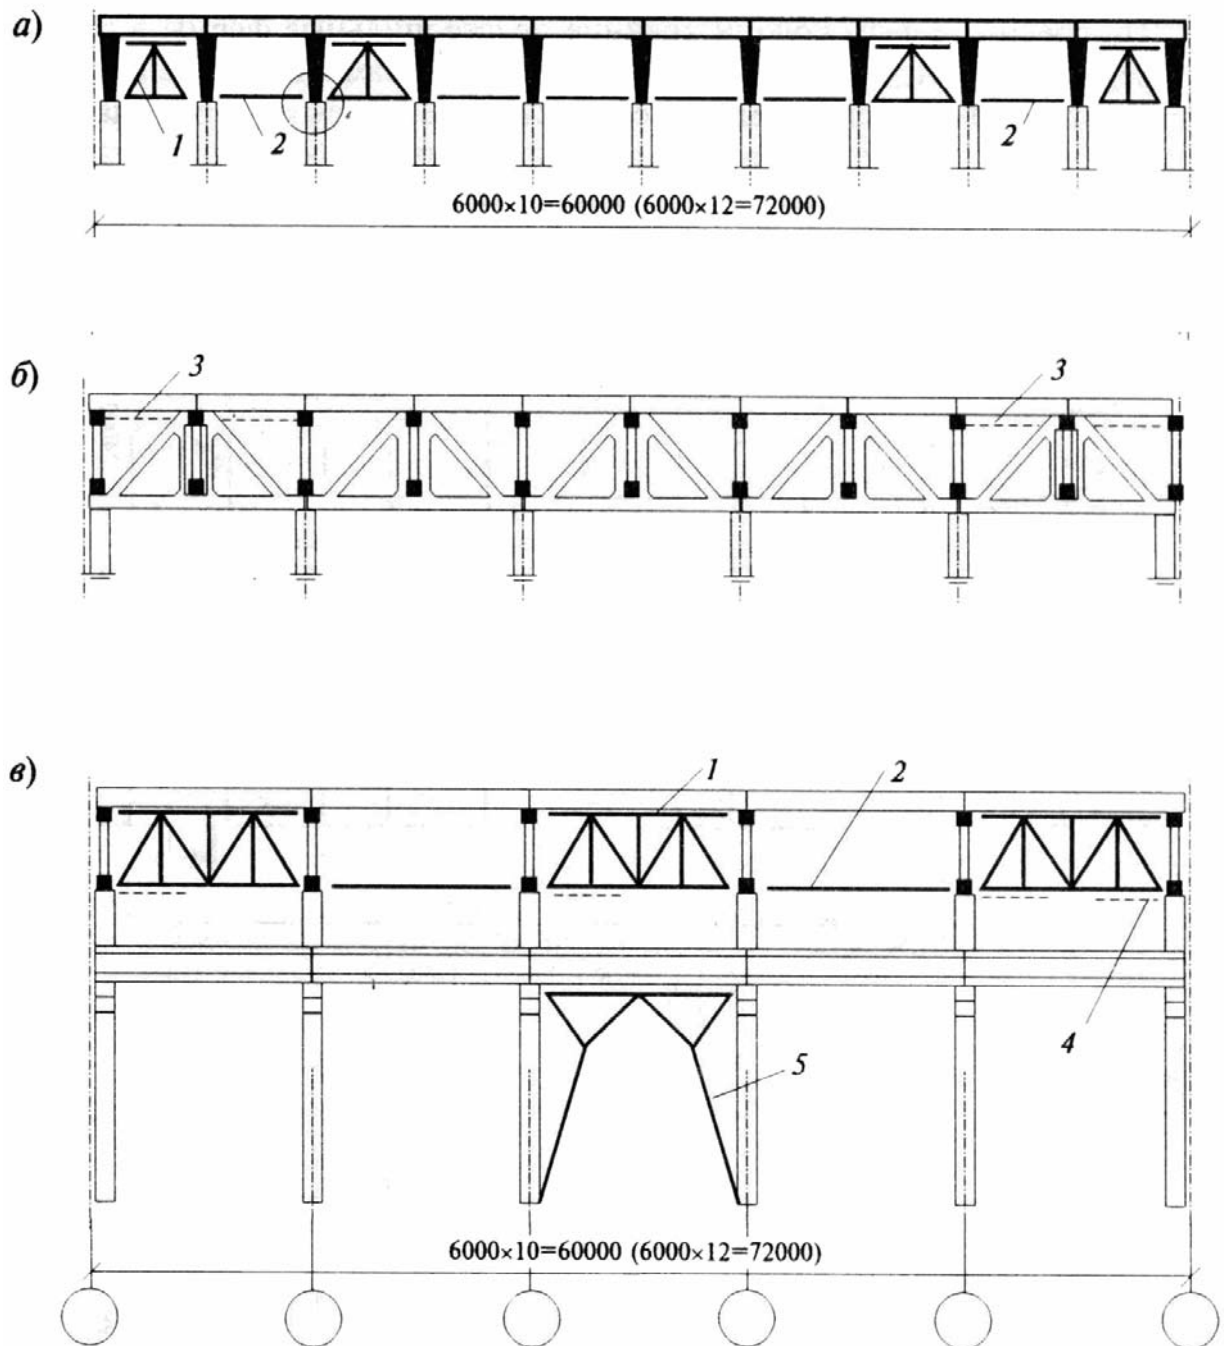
Связи в покрытиях при железобетонных стропильных конструкциях:
